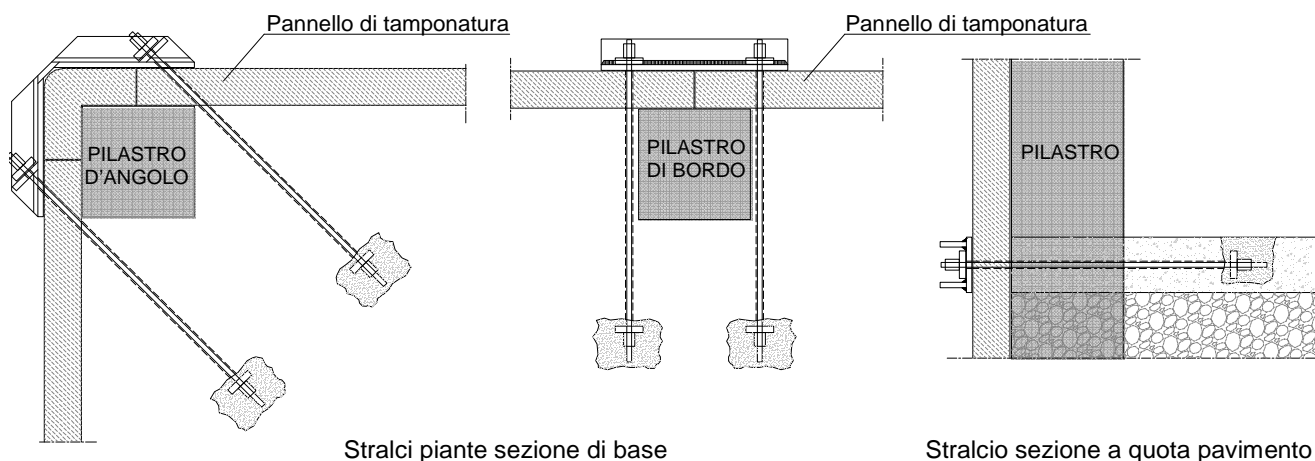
Particolari di solidarizzazione dei pilastri d'angolo e di bordo alla soletta di base
